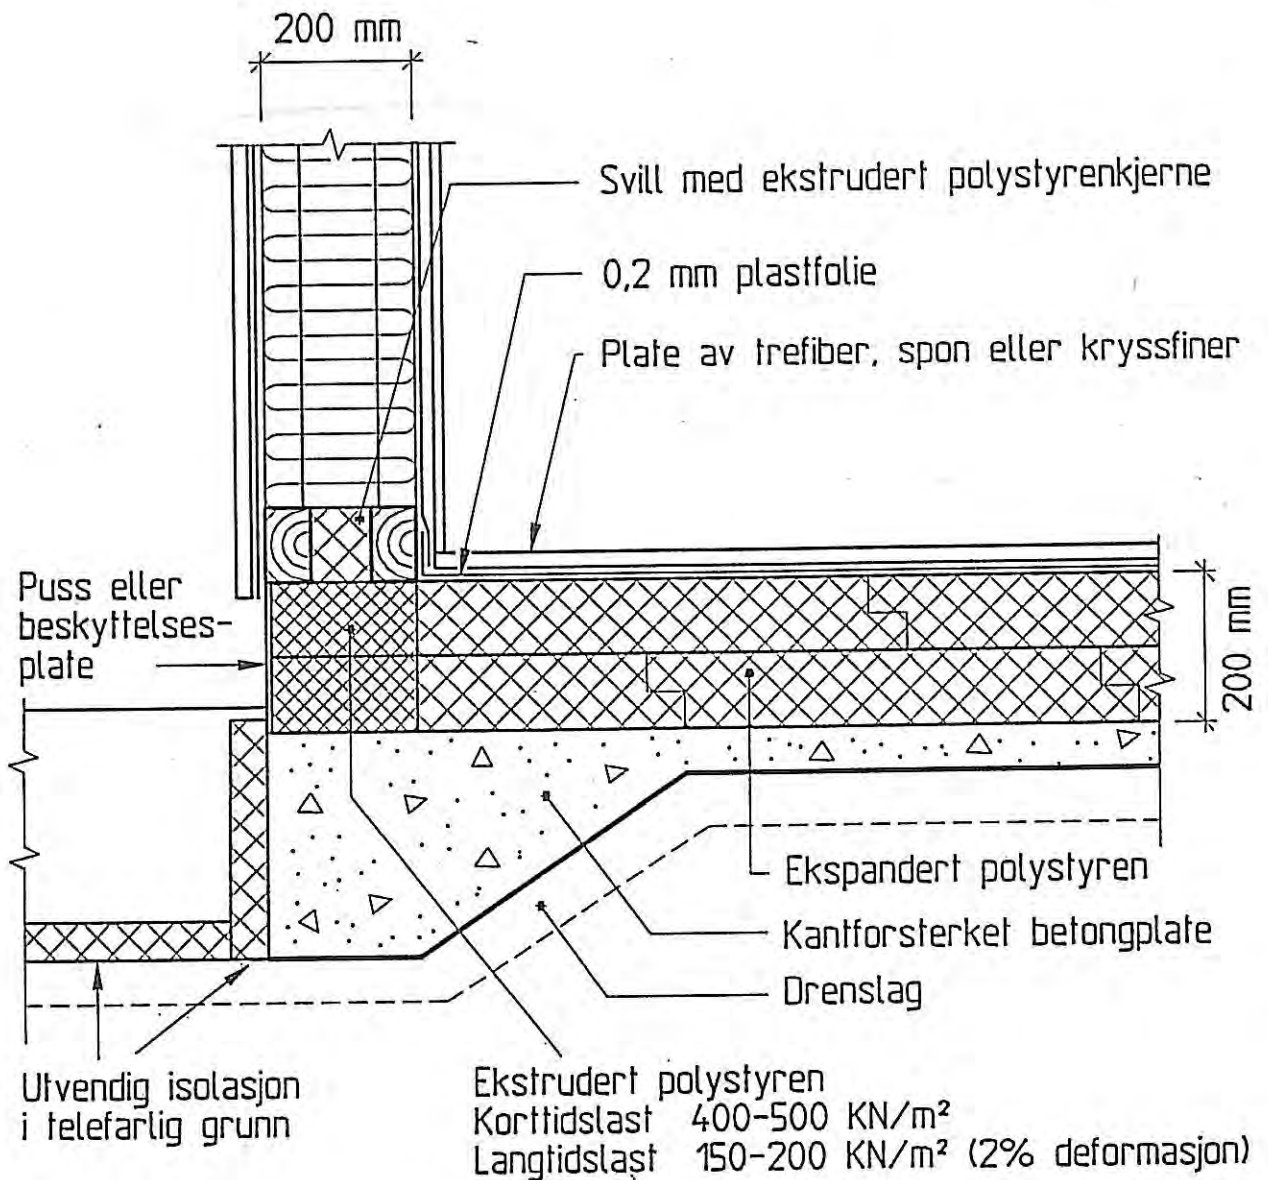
c. I telefarlig undergrunn med dårlig bæreevne kan ringmuren erstattes av en kantforsterket betongplate
